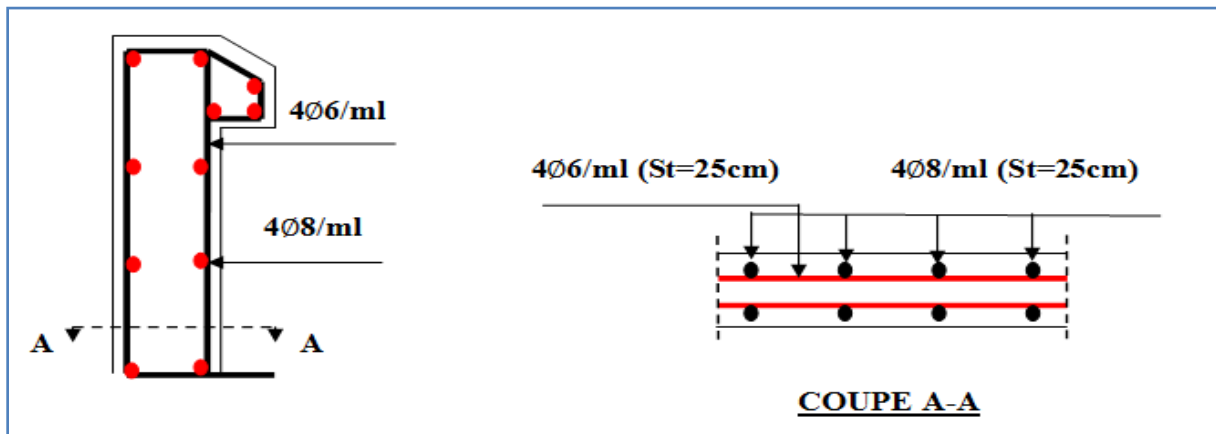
Schéma de ferrailage de l'acrotère (Terrasse inaccessible).
